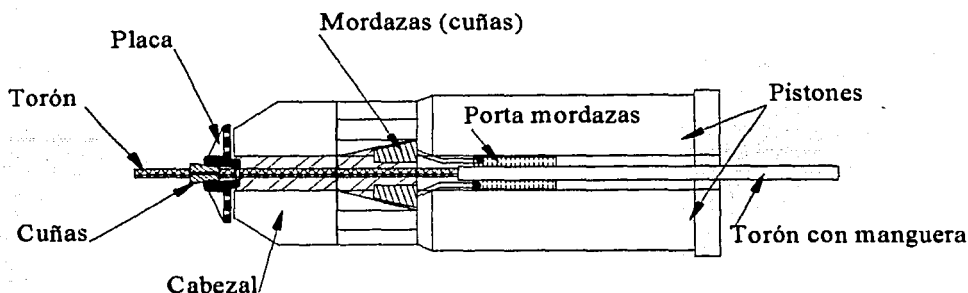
Instalación de anclaje para acañado de cable (vista posterior del gato).
